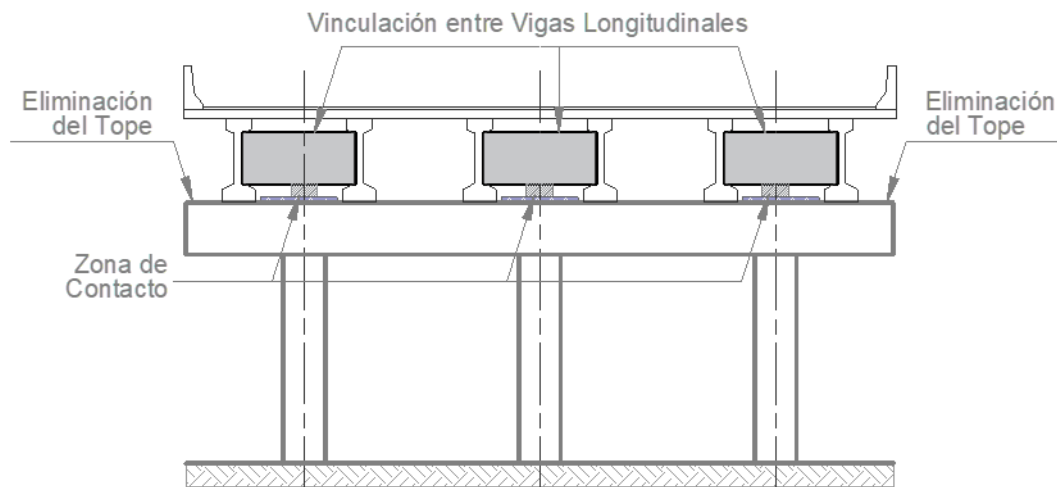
Esquema de aplicación del sistema de aislamiento por superficie deslizantes en el puente de calle Paso.
